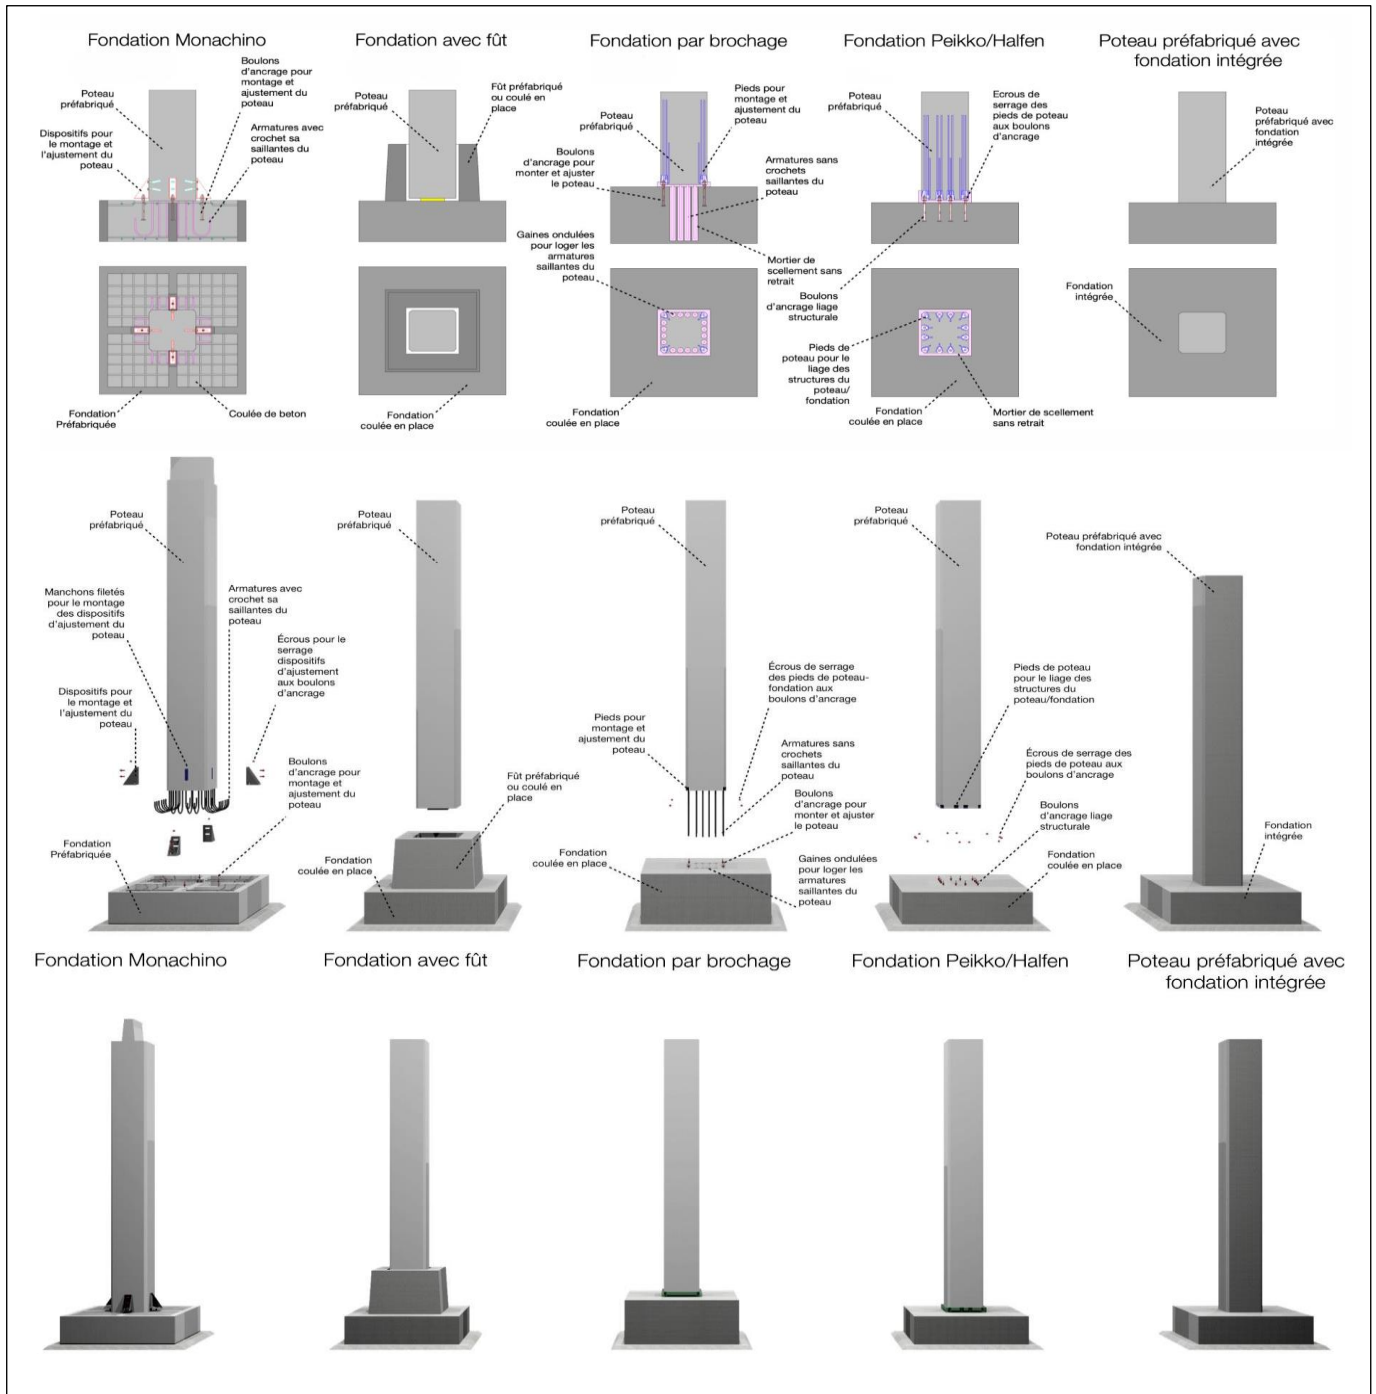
Différents types d'assemblages poteaux-fondations [26].
